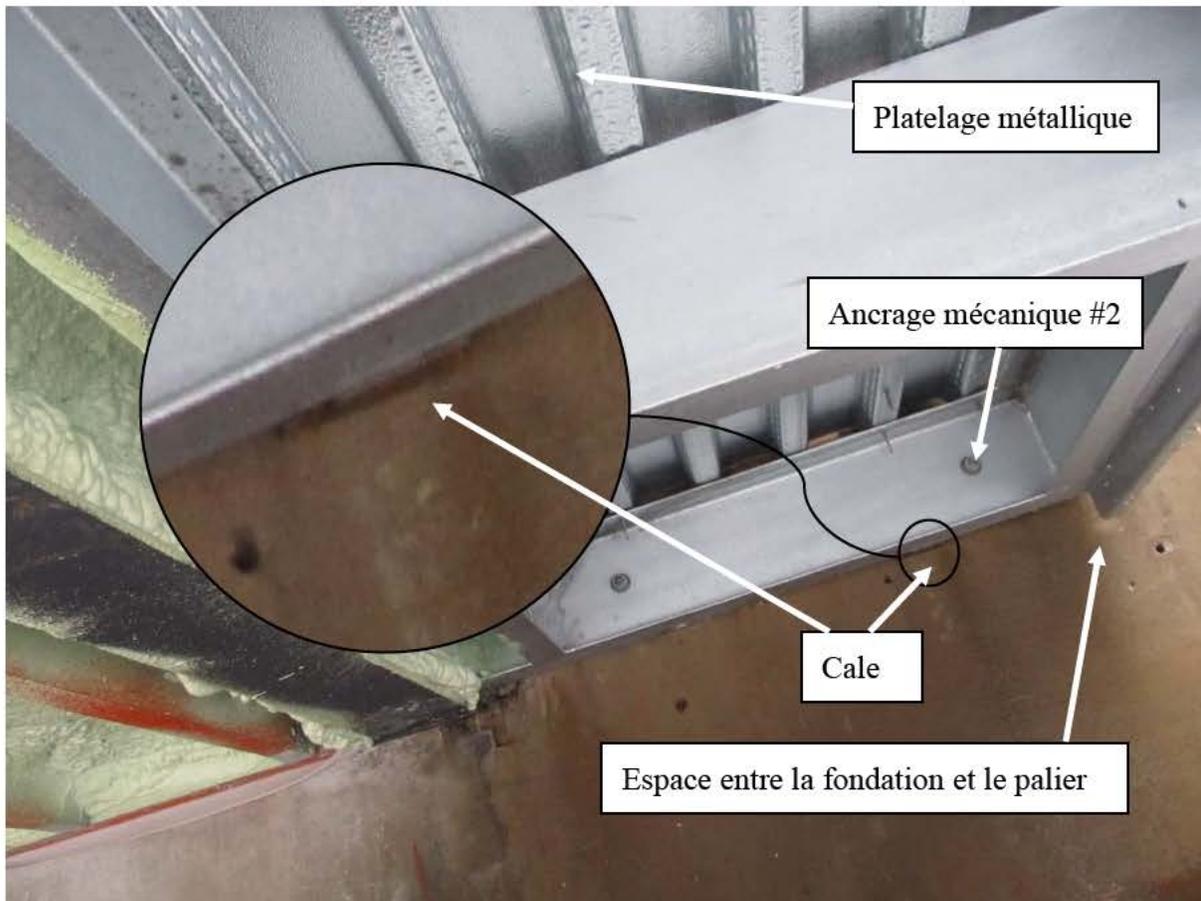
Dessous du palier de l'escalier à la suite de l'installation initiale
